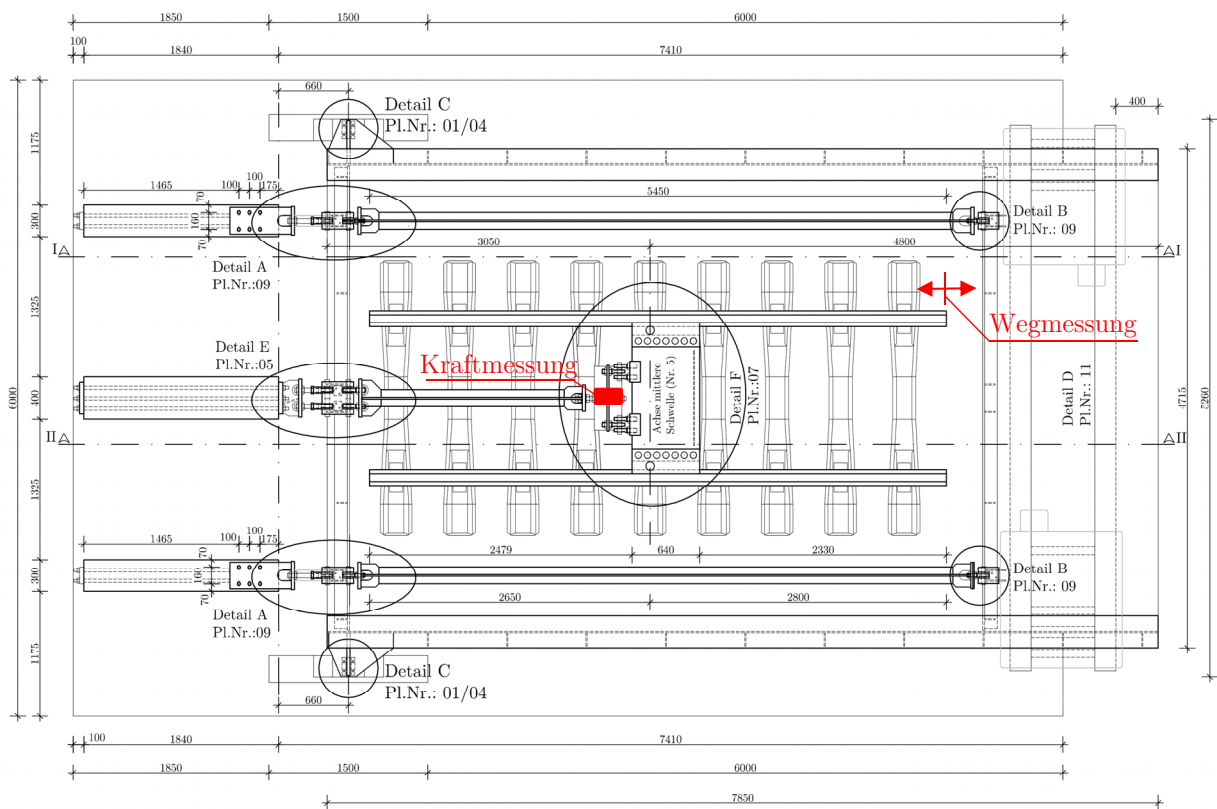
Grundriss der Versuchsanlage verwendet von Hackl [127]
